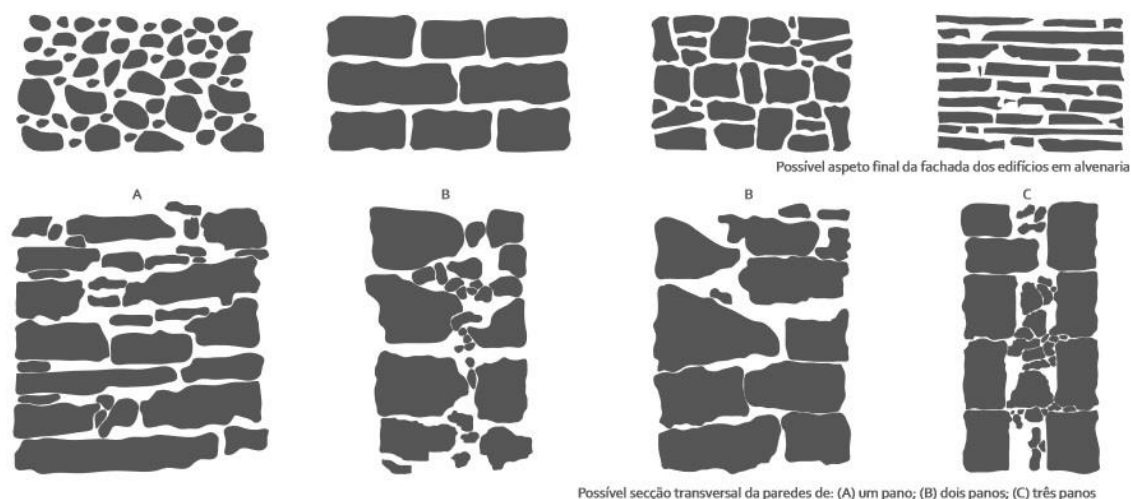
Vistas e secções transversais de paredes de alvenaria de pedra
